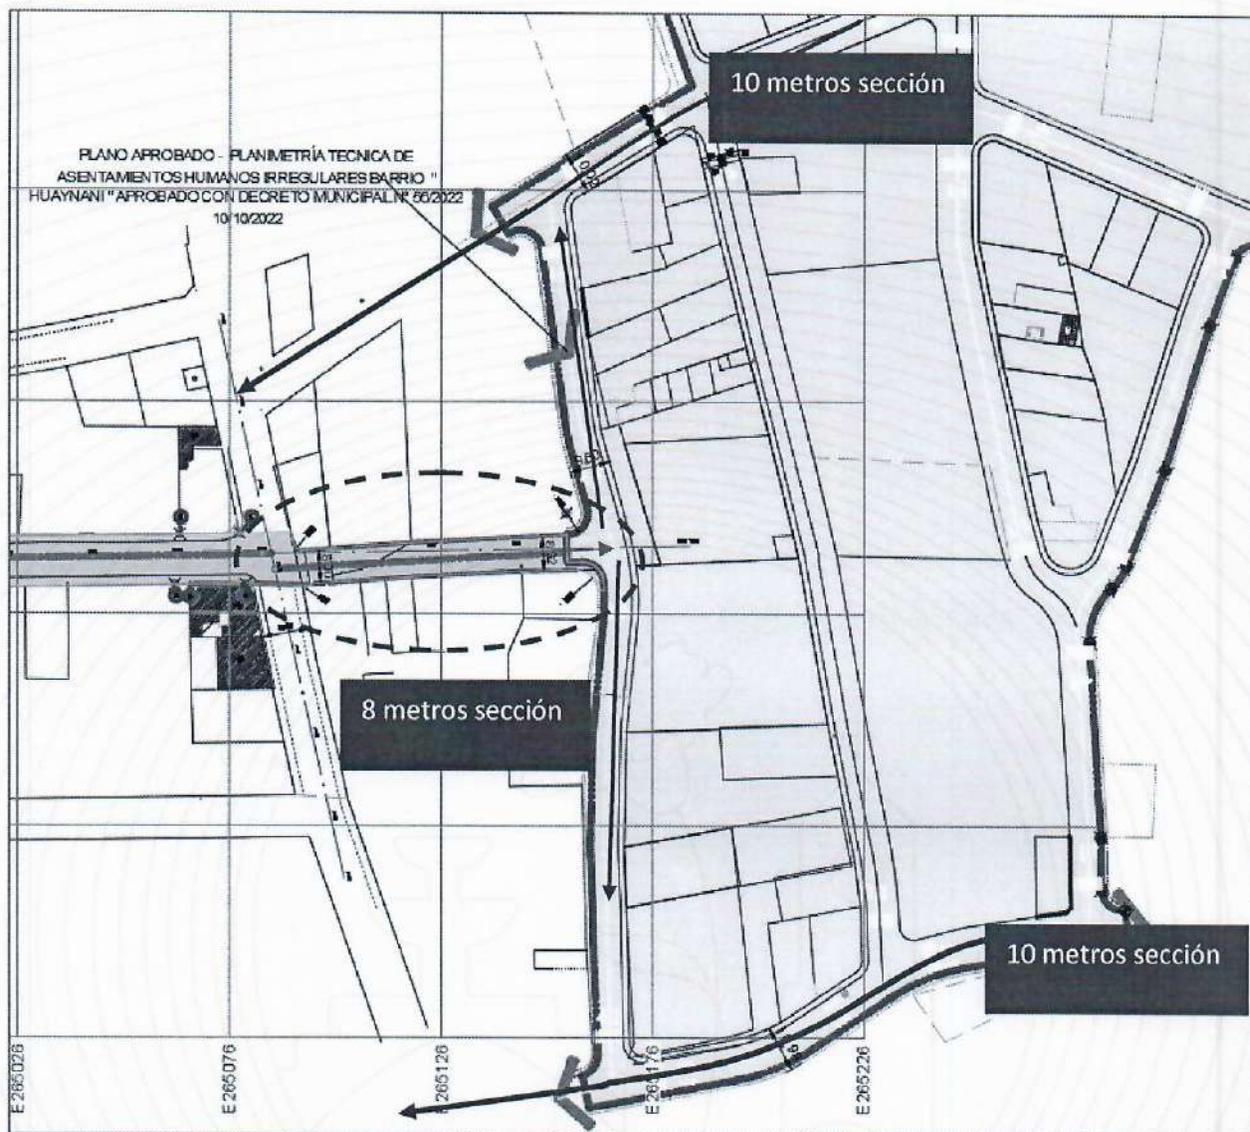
IMAGEN DEL ENTORNO DE LA VIA DE SECCIÓN DE 8 METROS
